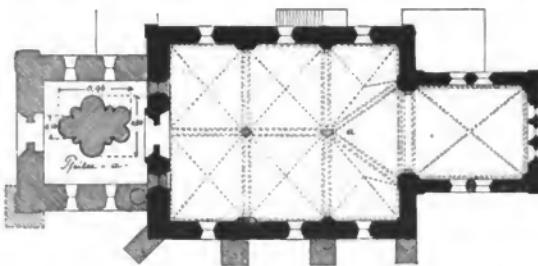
Grundriss der Kirche. 1:20.
